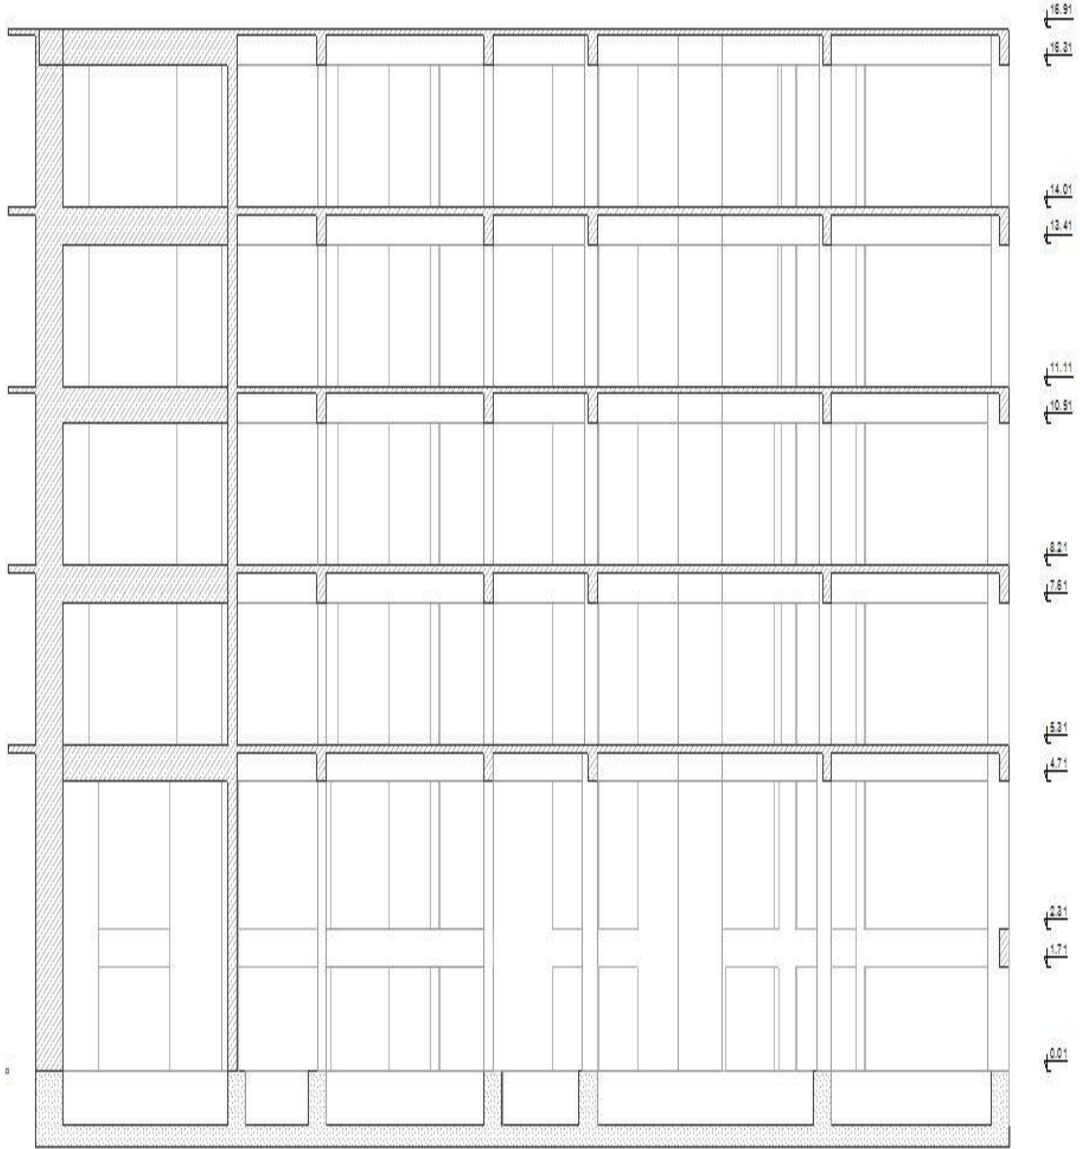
Tip 8 Uygulamasında Bina Planı
